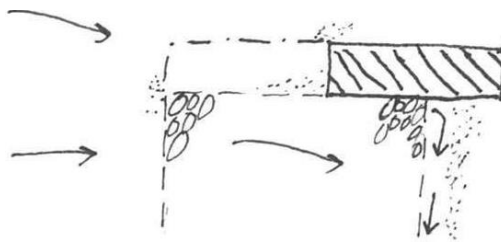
Bovenaanzicht met beginnende zijdelingse pipegroei aan de benedenstroomse zijde van de grofzandbarrière.
